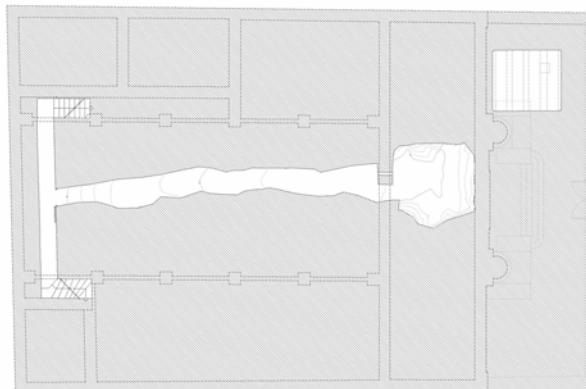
Planta de la Sala de Reflexión, bajo el edificio y su acceso.
